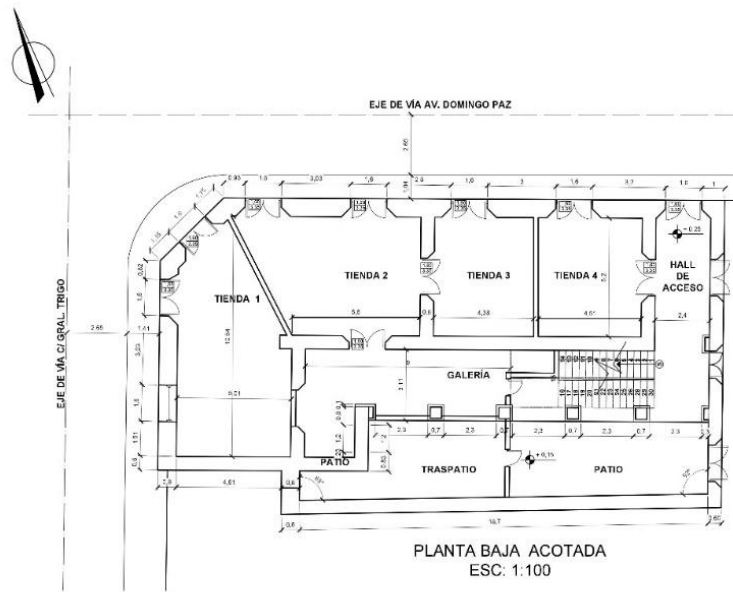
Planta Baja Acotada, Relevamiento Métrico.
